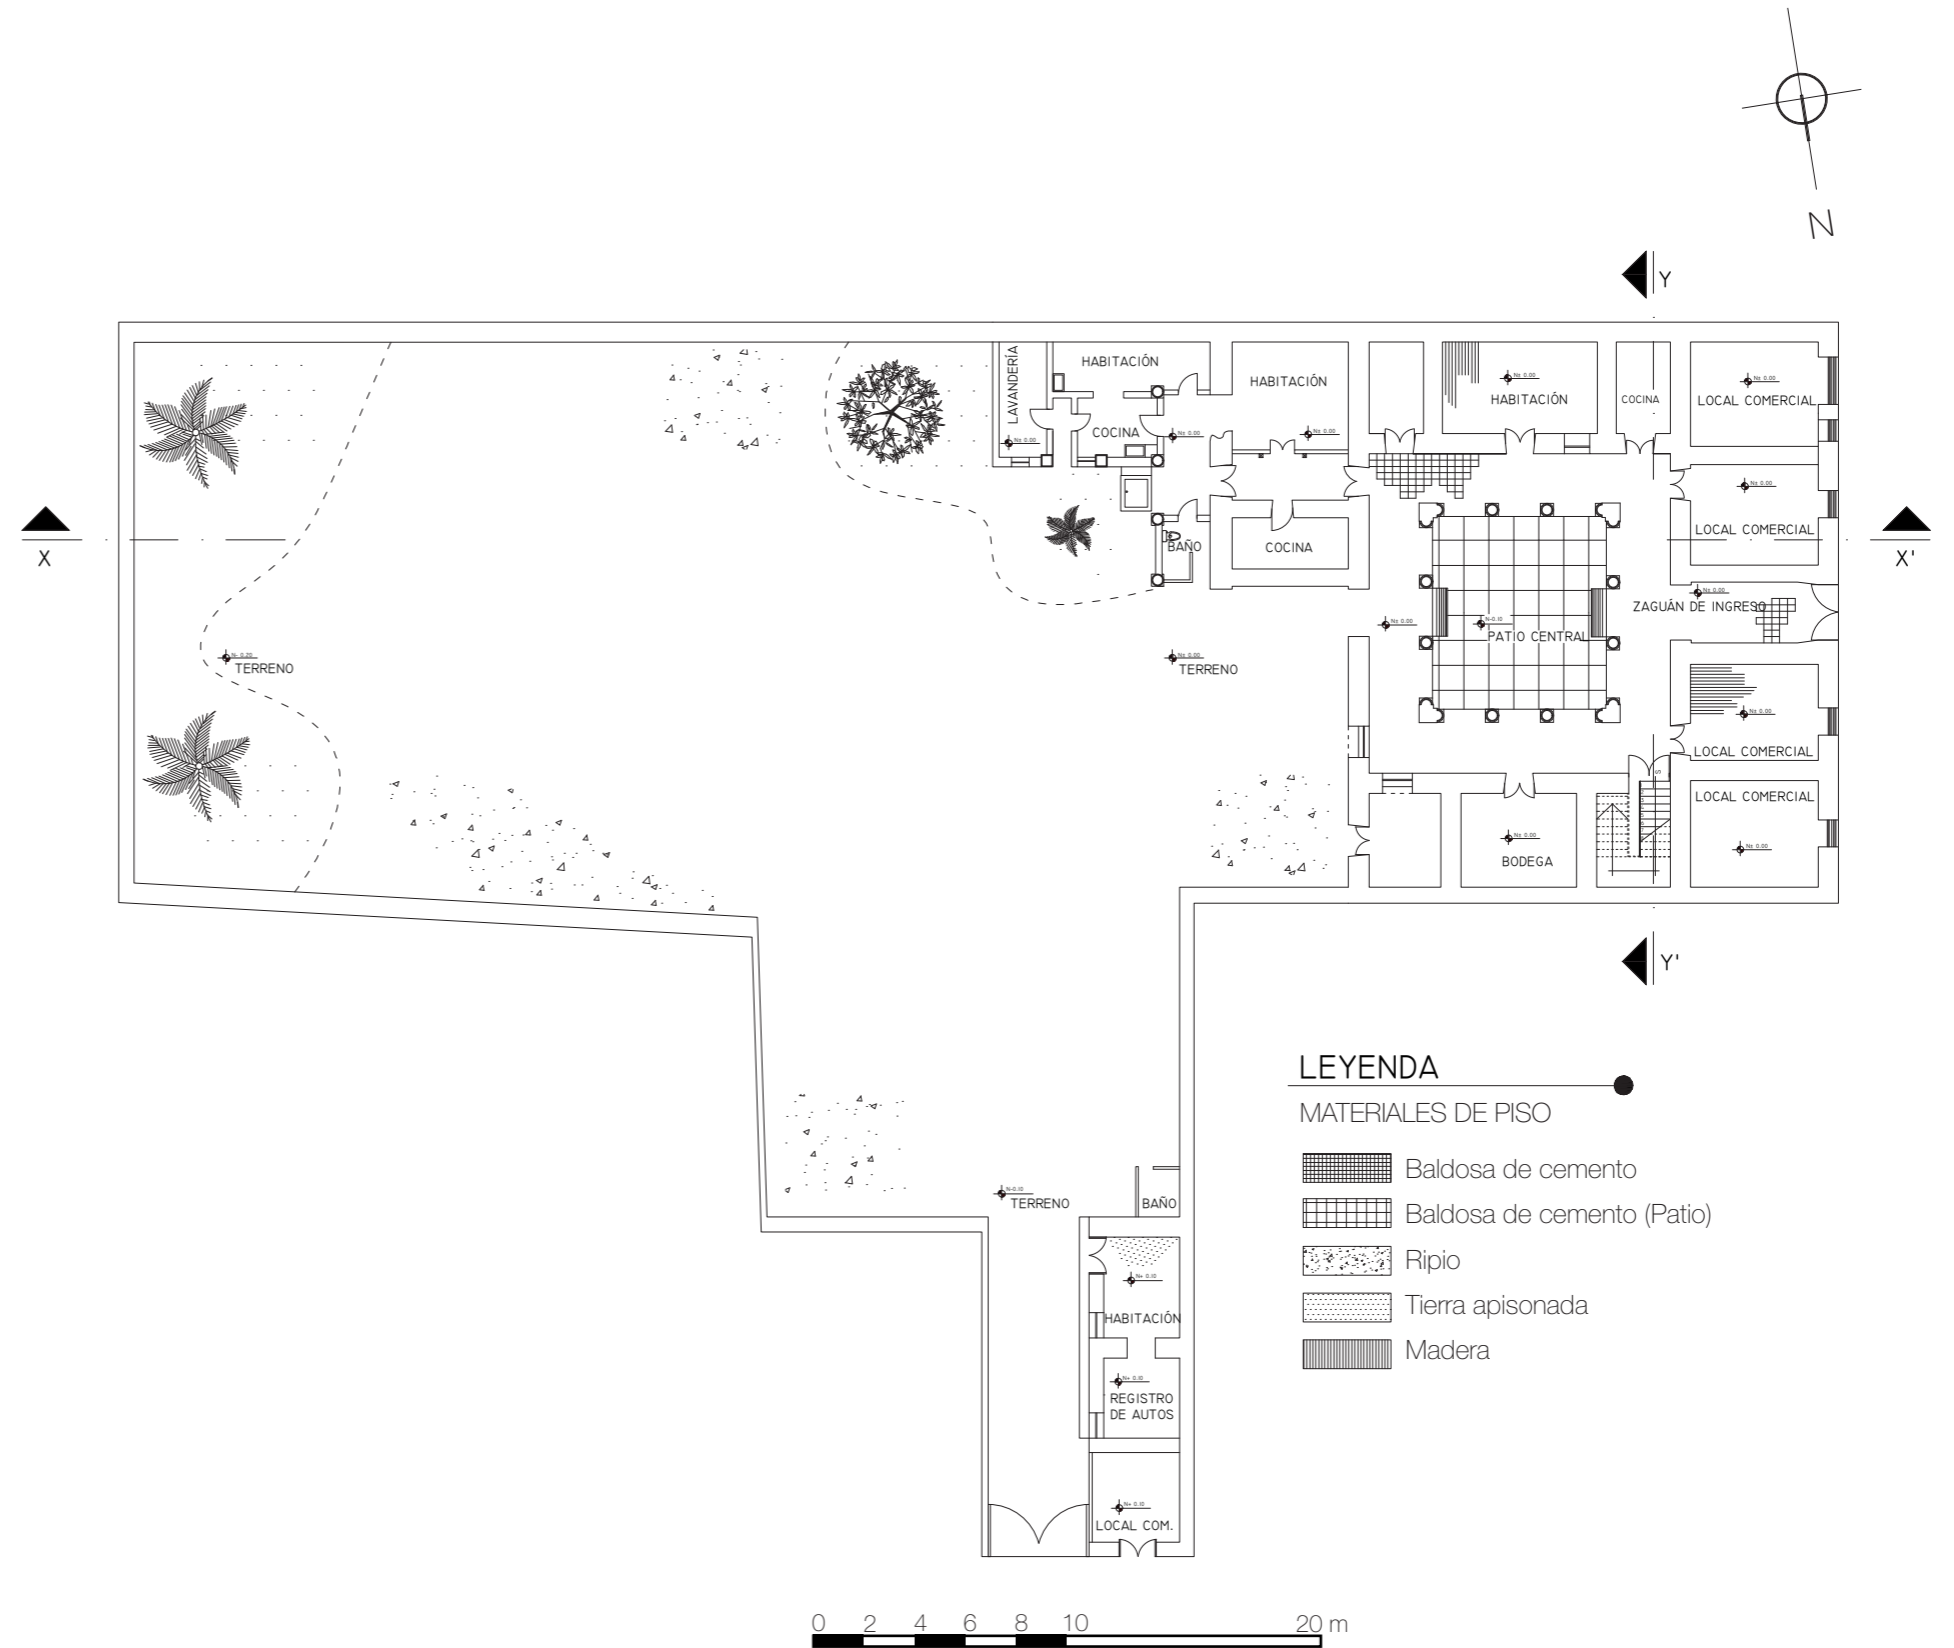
PLANTA NV. 0.00- ESTADO ACTUAL
